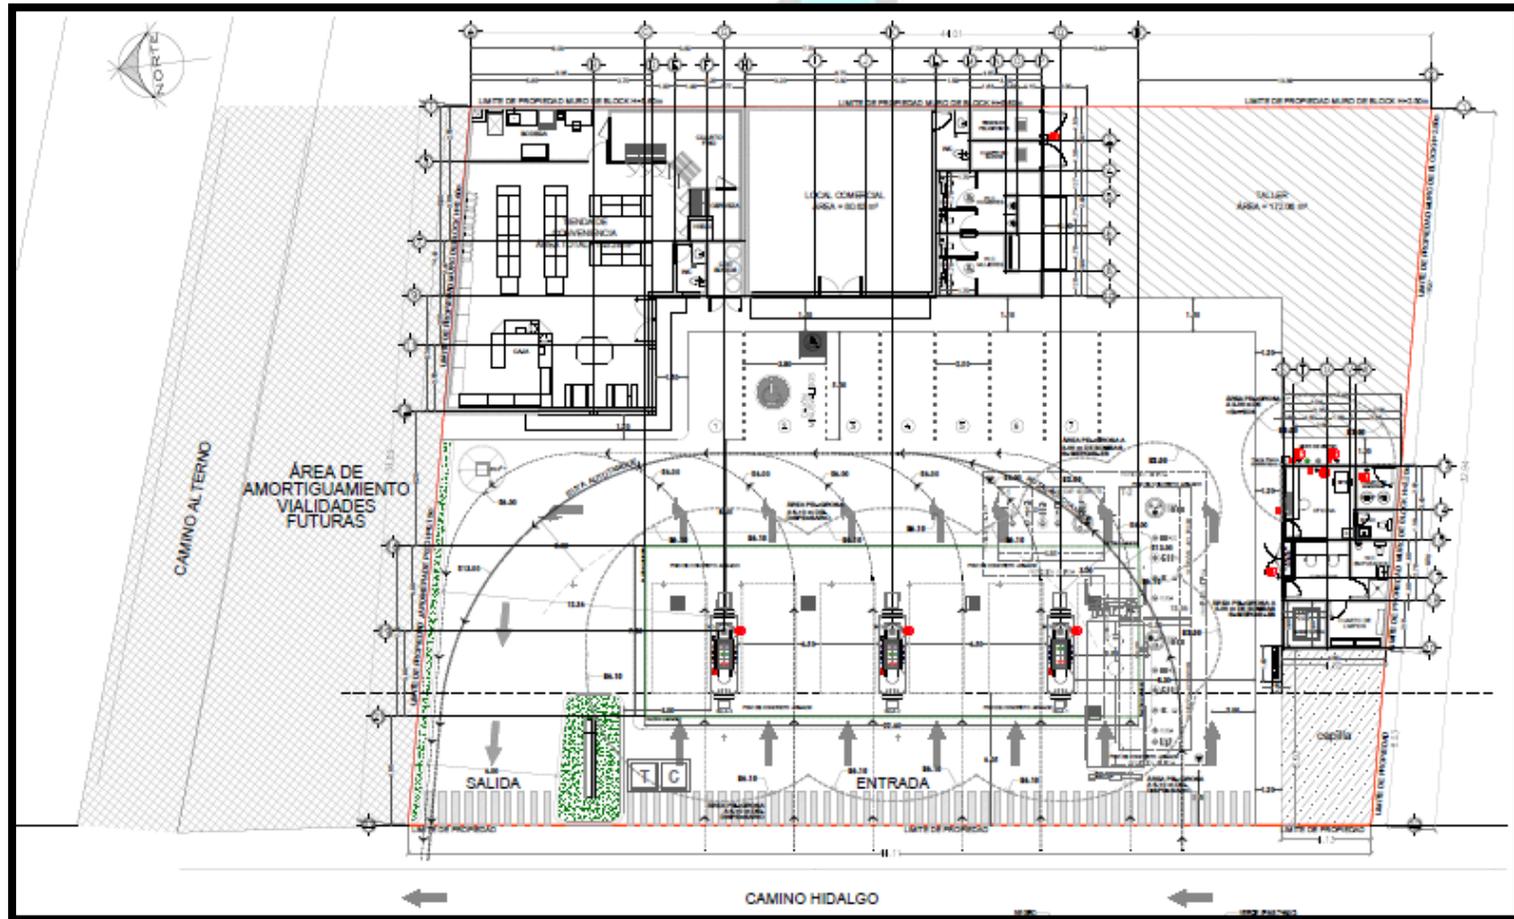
Proyecto arquitectónico, Planta de conjunto
